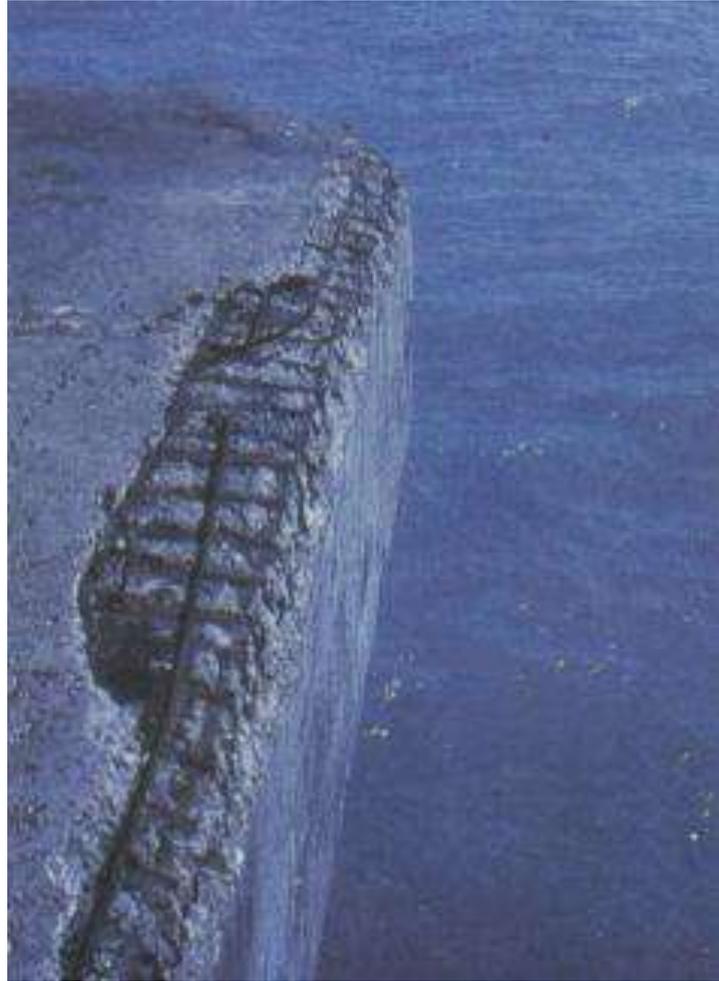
Corrosão de armadura por cloretos em estrutura de concreto em zona portuária. Foto altoqi.com.br
